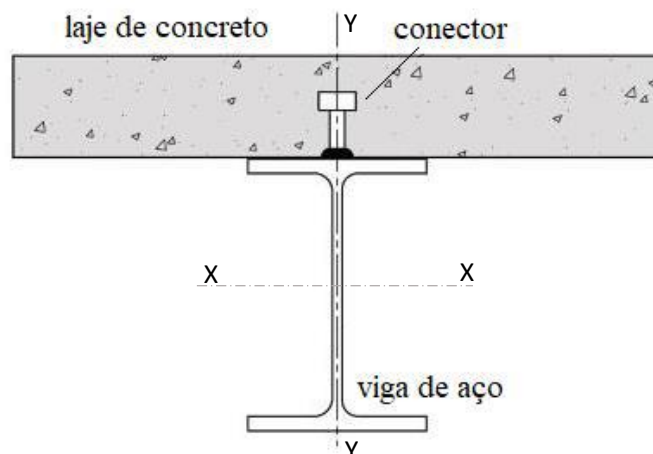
Seção transversal típica de uma viga mista de aço e concreto
